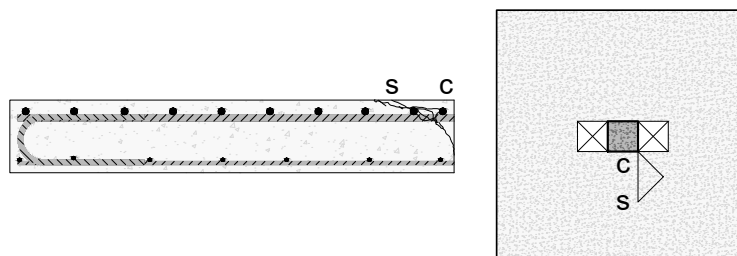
Padrão de fissuração da laje LFE2 - corte
